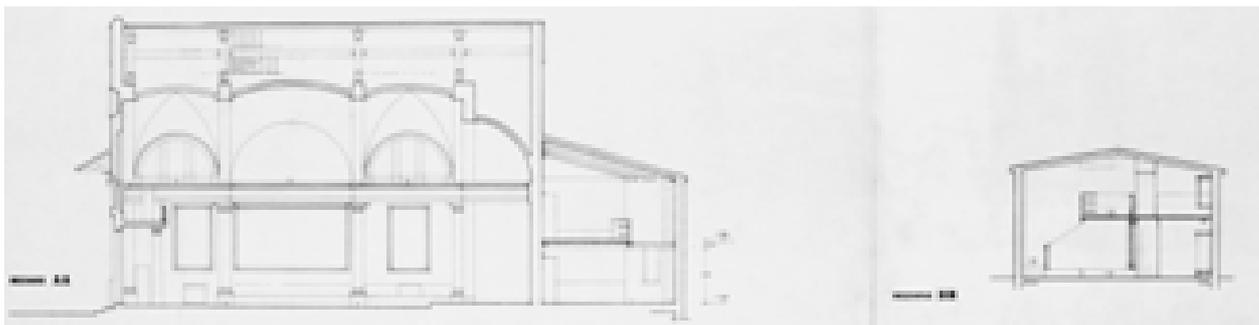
Sezioni AA-BB – Stato di progetto – 24/02/1981 (AABS-94.053)
